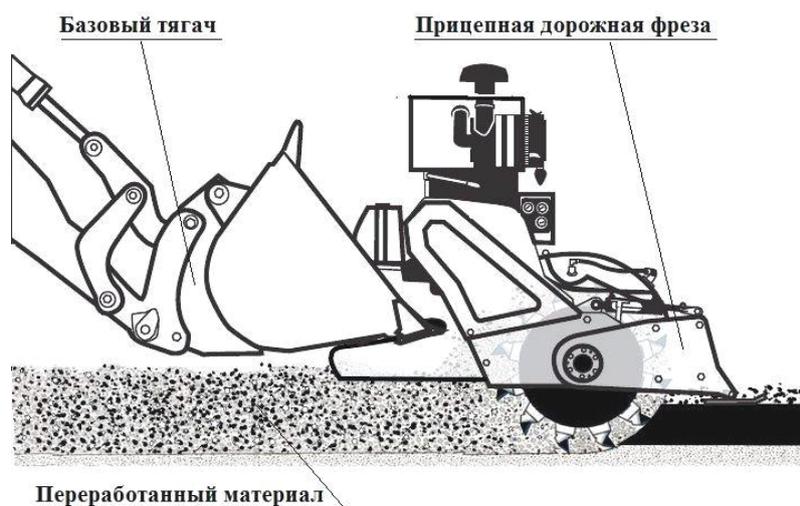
Схема фронтальной установки прицепной дорожной фрезы
